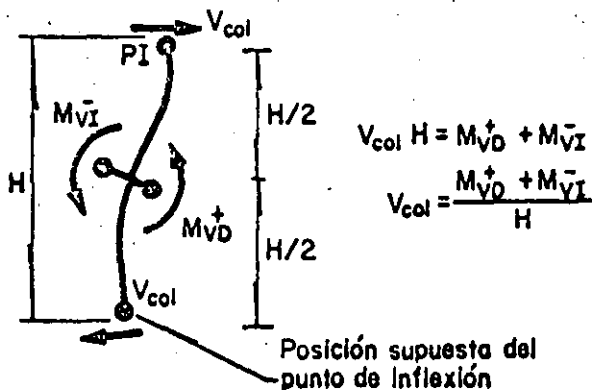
Fuerza cortante actuante en la columna, para el mecanismo de "columna fuerte-viga débil"
